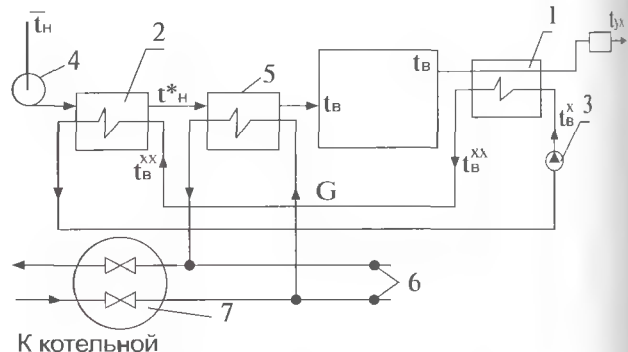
Схема использования теплоты вентиляционных выбросов в вентилируемом помещении:
